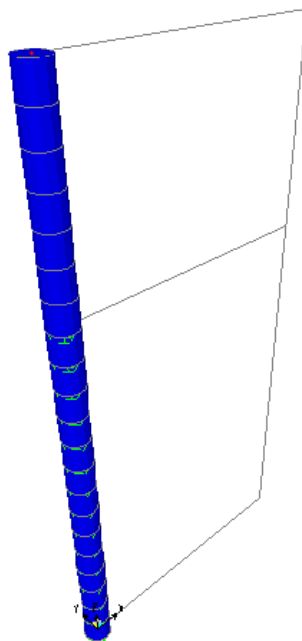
Pilar e tubulão reto, visão extrudada. Fonte: SAP2000.
